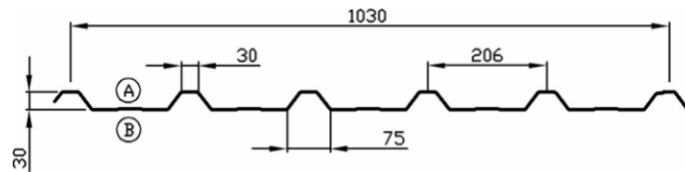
Dimensiones sección transversal. Fuente: Web del fabricante.
